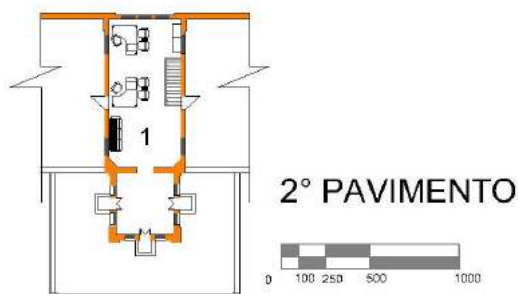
Planta do Pavimento Superior da Estação da Goiás – Projeto de Restauração e Adequação da Estação da Goiás – Centro Administrativo de Araguari
